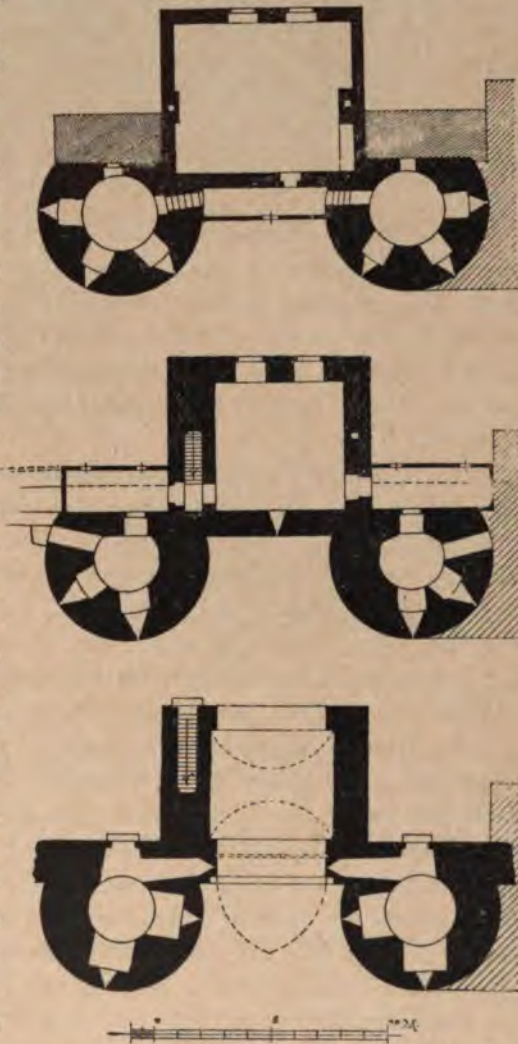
Jülich. Grundrisse des Rurtores.
